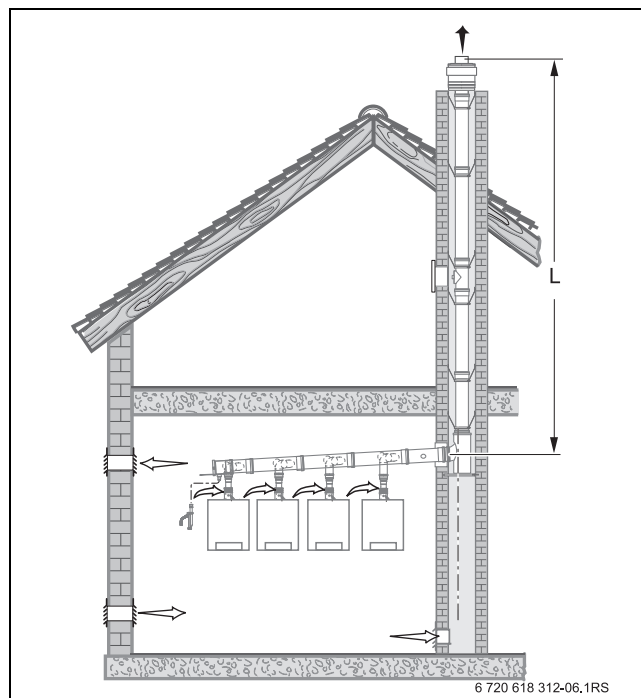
Montážní varianta se stavební sadou FU/ LAS-K
